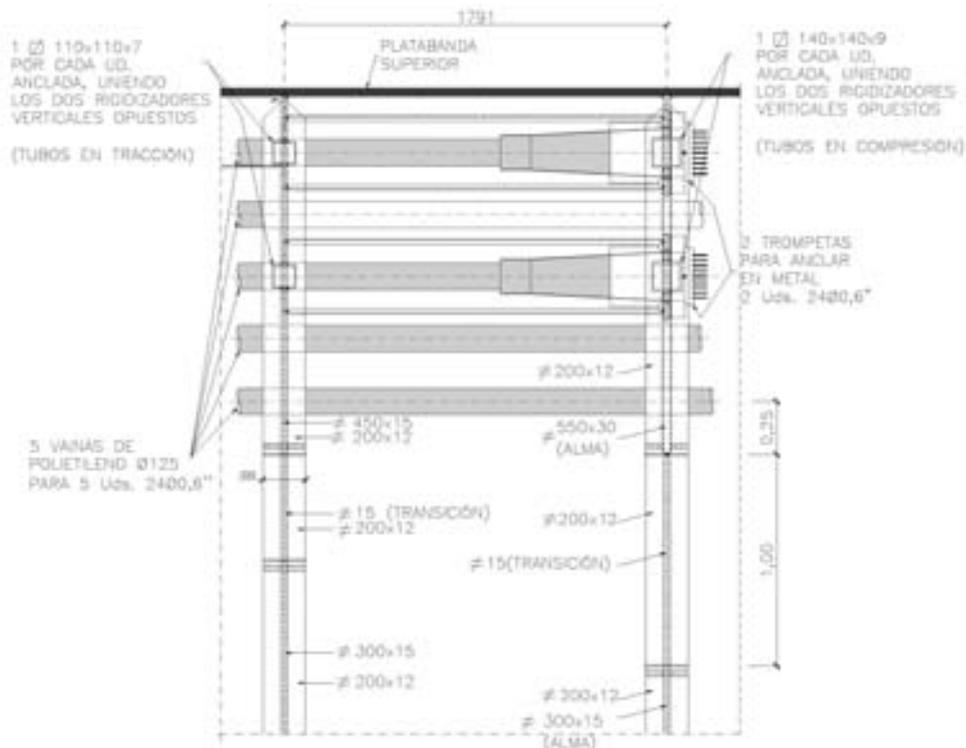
Detalle de anclajes de pretensado en el tramo mixto.
